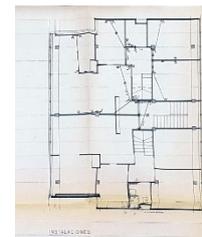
Planta primera dúplex Instalaciones B-3-5. 1964. Fuente: Archivo Municipal da Coruña
